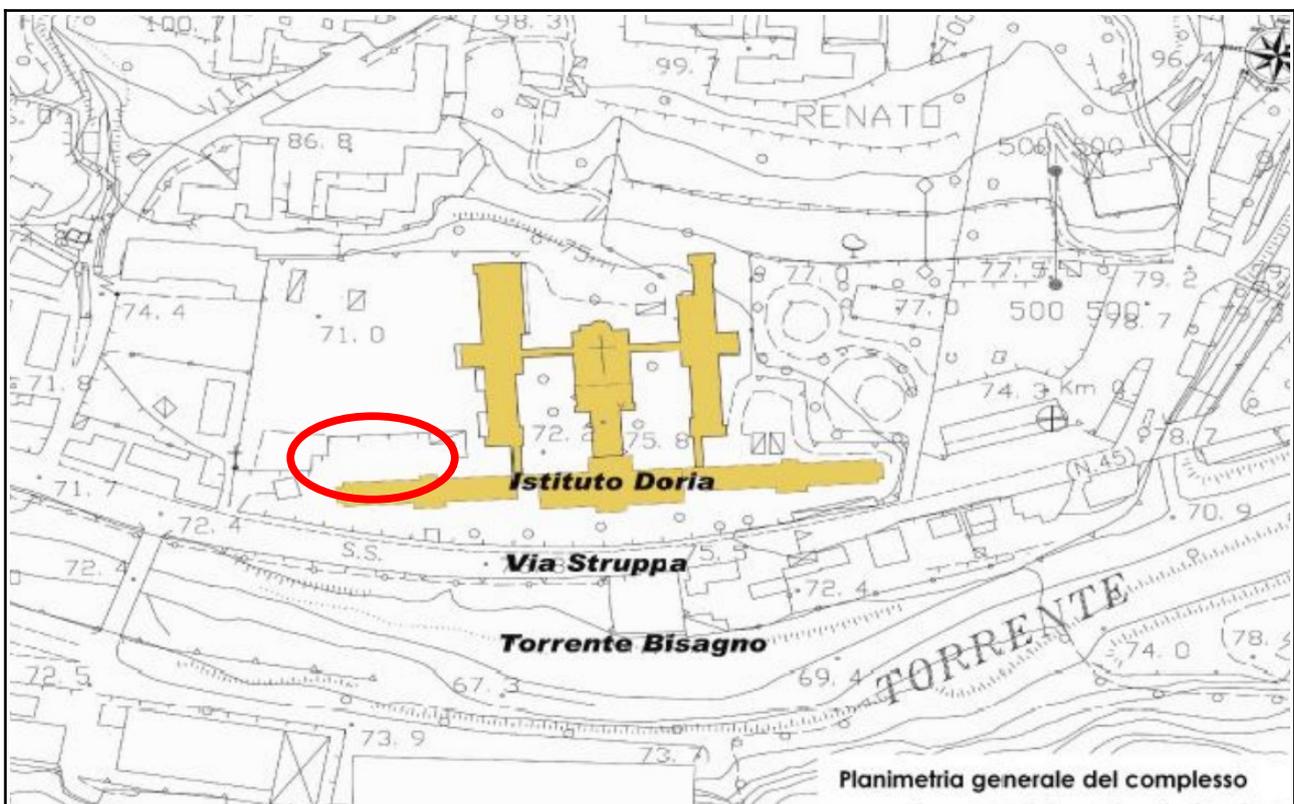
Planimetria generale del complesso con evidenziato il sedime di intervento
